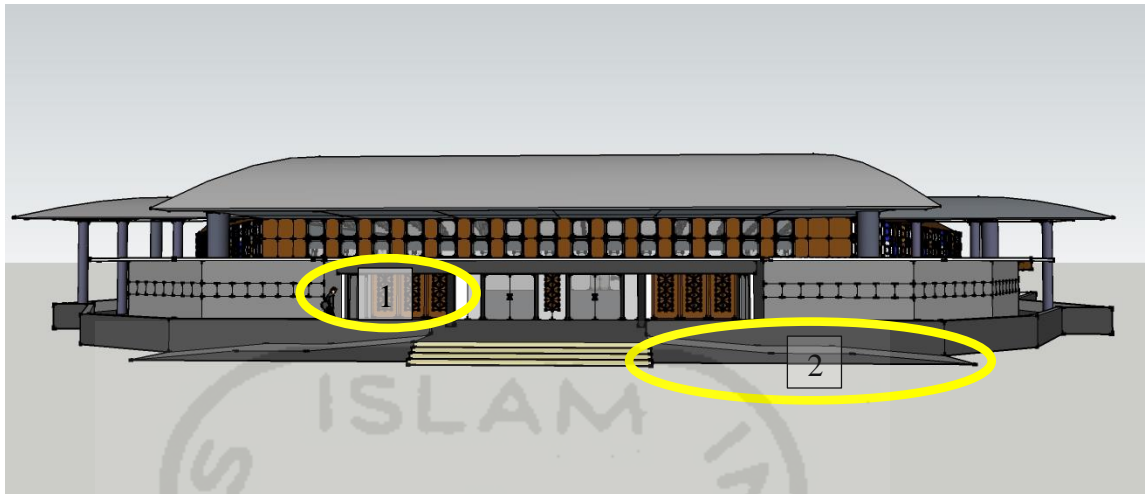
12. Ornamen Pada Fasad Bangunan.
